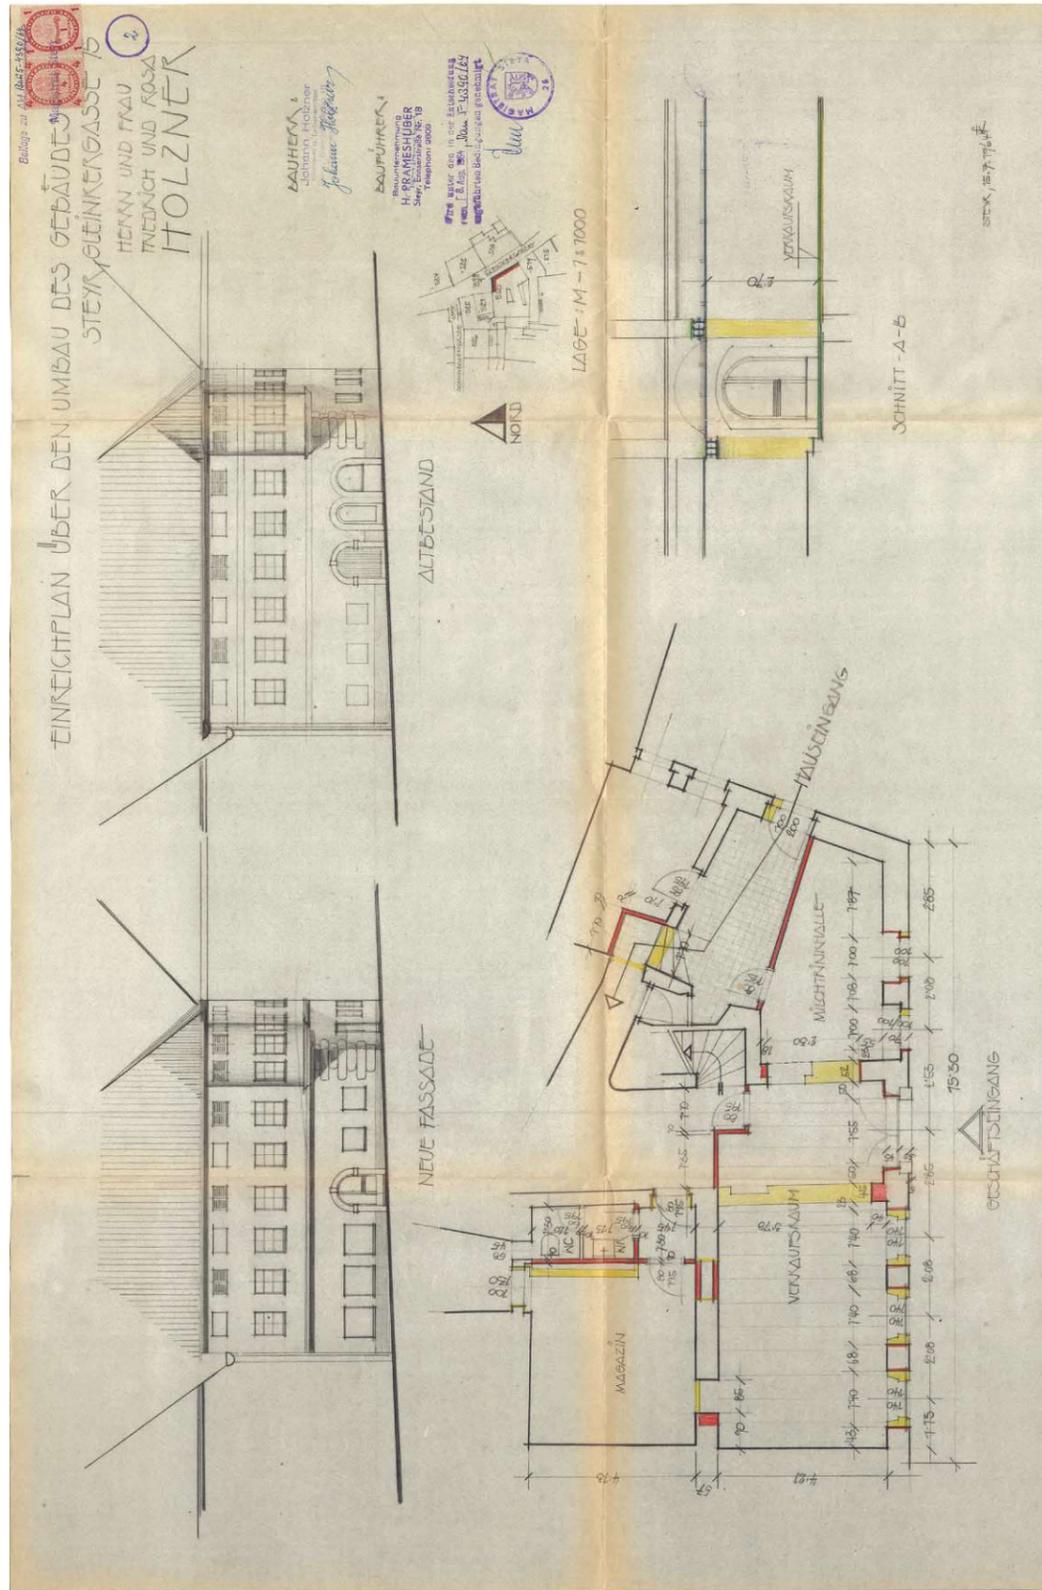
Plan für einen Straßenseitigen Verkaufsraum
